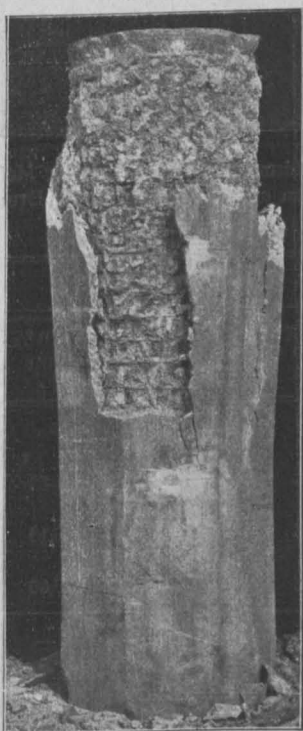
Das Abfallen der äußeren Betonschale (Körper 1, Reihe II).
